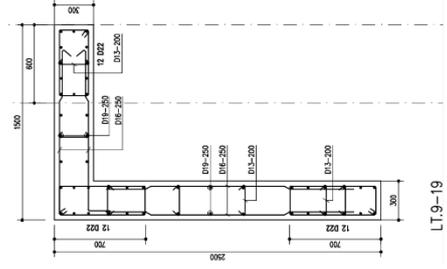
Denah Rencana *Shear Wall* Lantai 16-20
